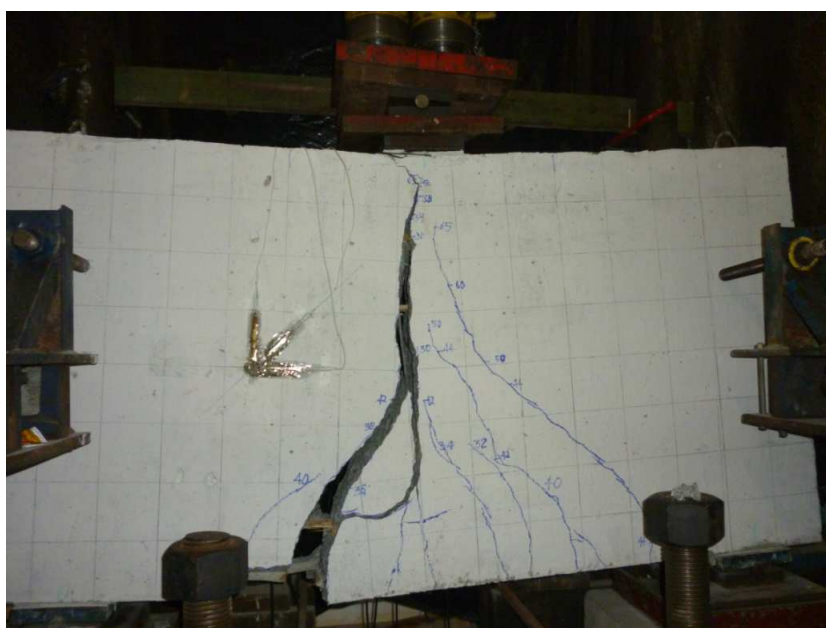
Configuração de fissuras - Viga V2-1.
